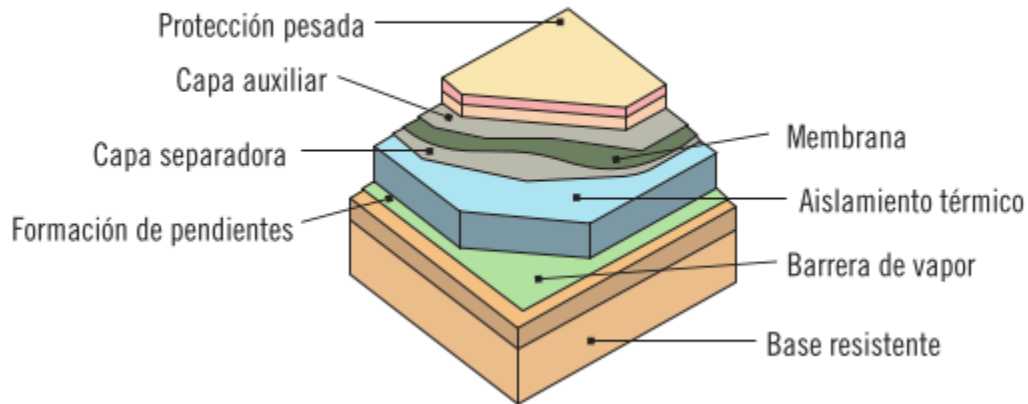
Aislamiento bajo la impermeabilización de una cubierta plana.
